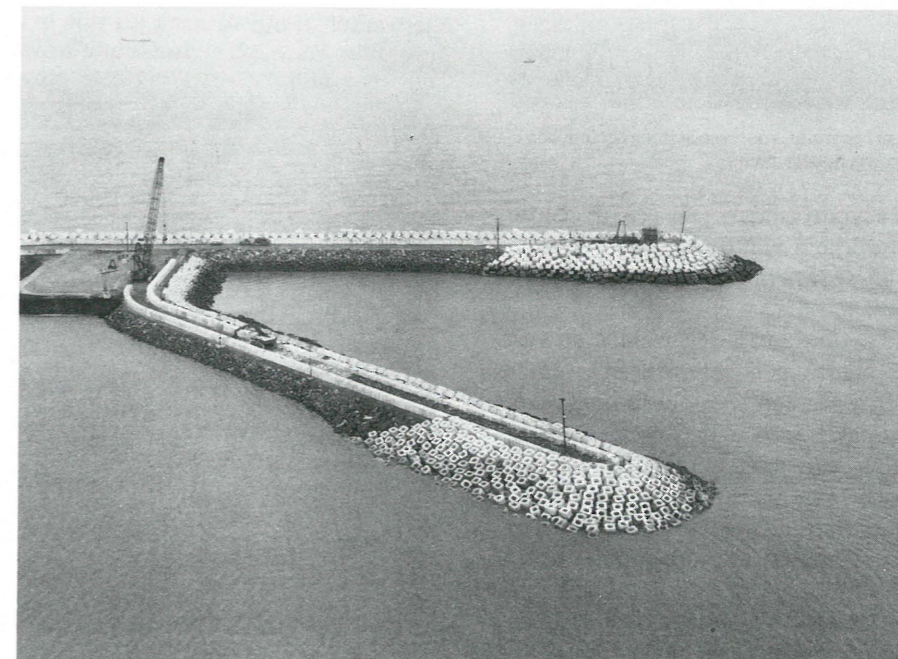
Het „Haro-blok” als deklaagelement voor stortsteendammen.
